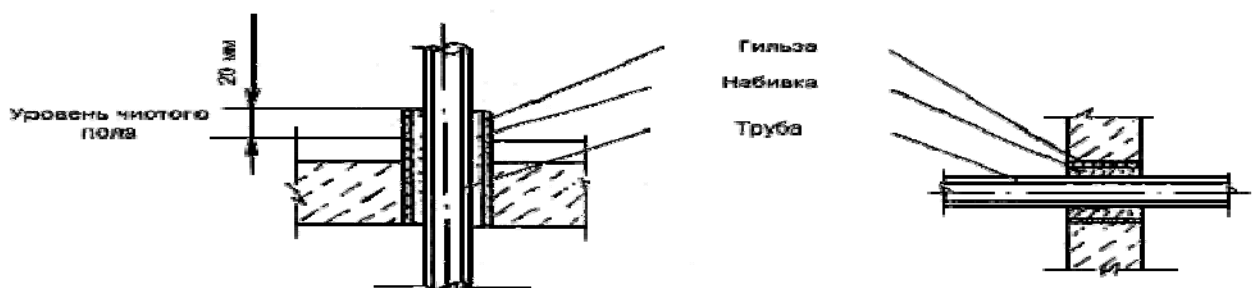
Установка гильзы для прокладки труб в стенах и перекрытиях».
